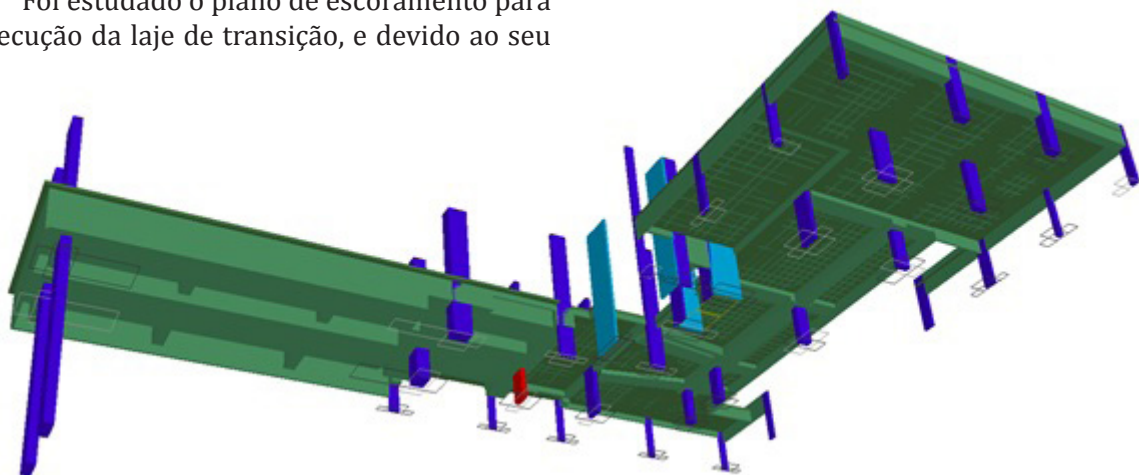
Modelo estrutural do pavimento de transição
